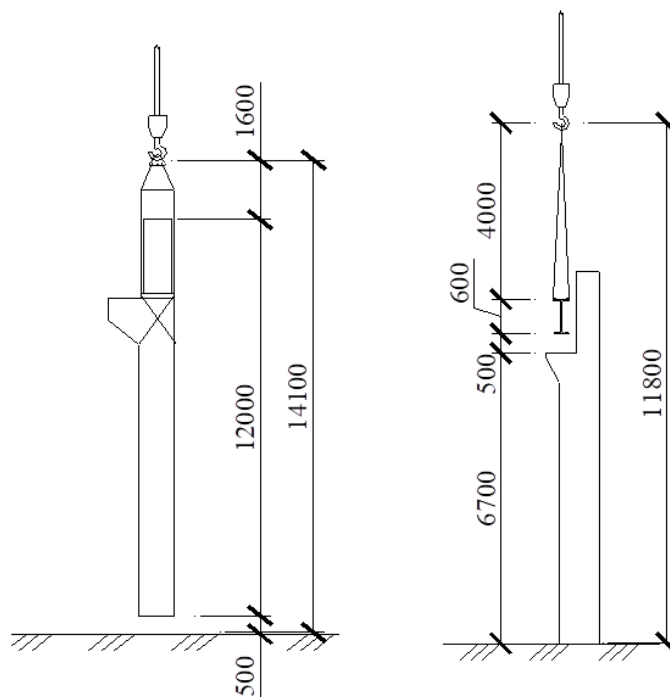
Схема монтажа колонн и подкрановых балок
